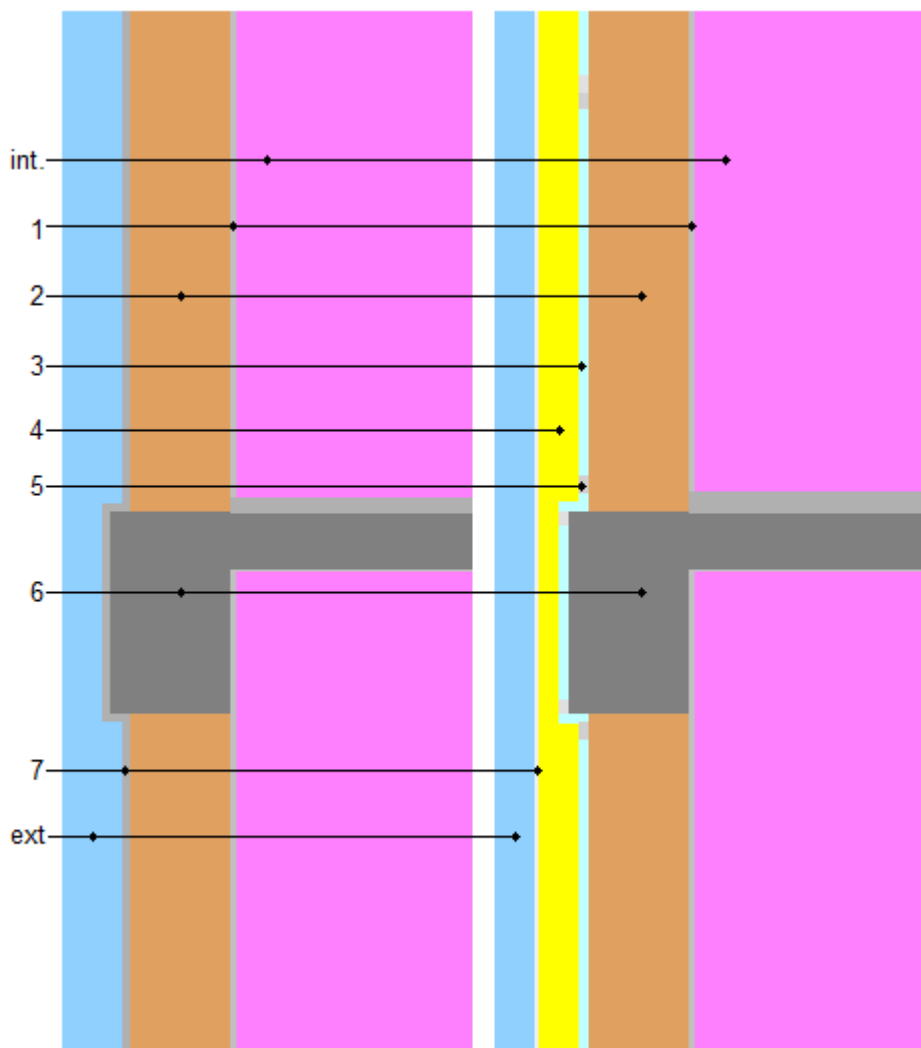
Intersecție planșeu din beton armat cu perete exterior
